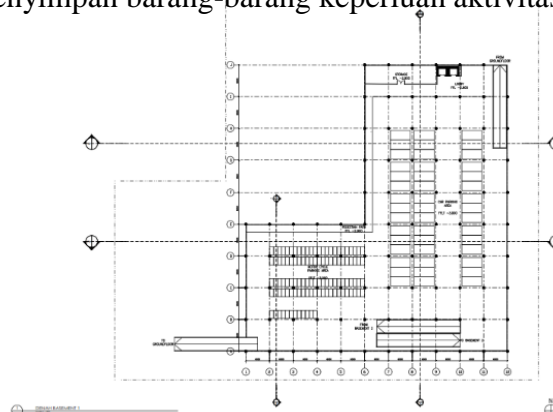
Denah Lantai 1 Bangunan Utama
